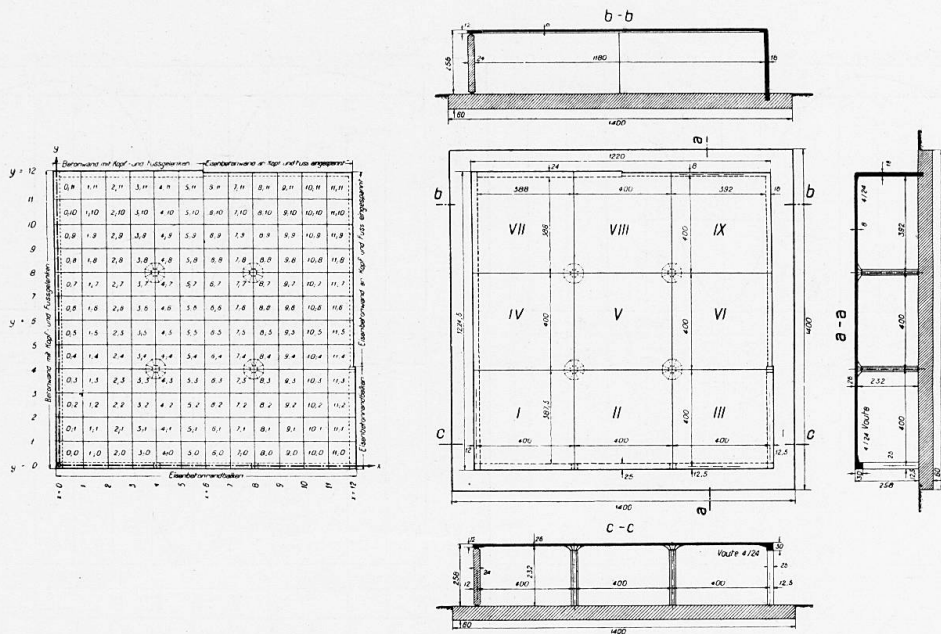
Mur de béton avec articulations en tête et en pied = Betonwand mit Kopf- und Fussgelenken = Concrete wall with joints at top and bottom.
